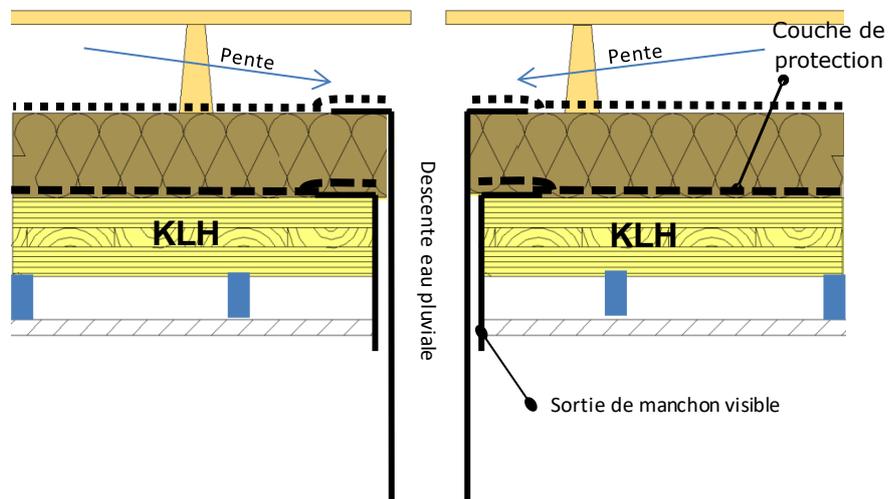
Dispositif de contrôle de fuite au niveau des descentes des eaux pluviales en terrasses accessibles aux piétons et au séjour
